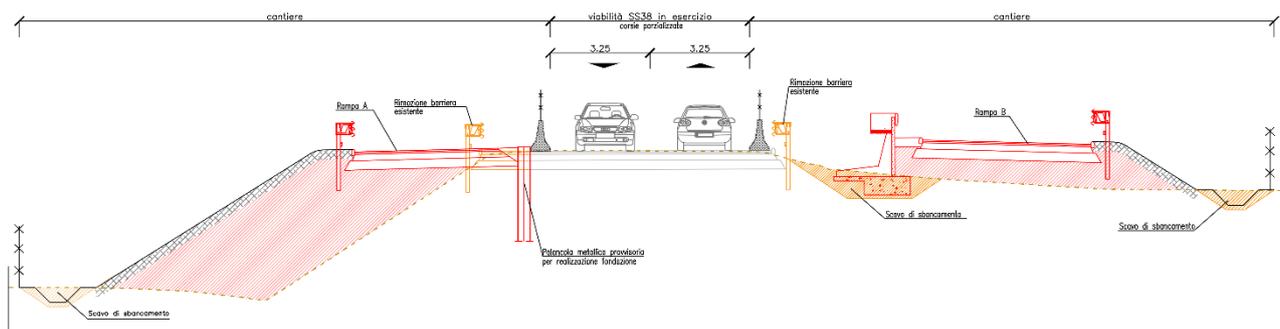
Sezione A-A Fase 3 Variante S.S. n. 38
